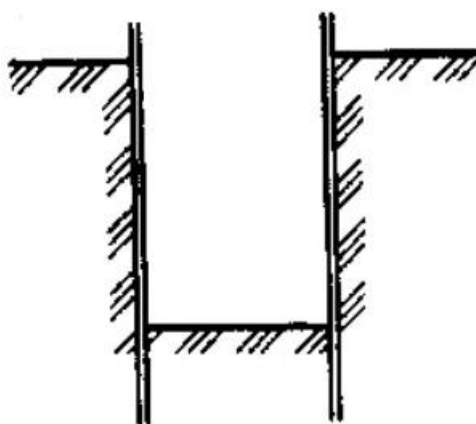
Схема крепления стенок котлованов простыми инвентарными щитами
